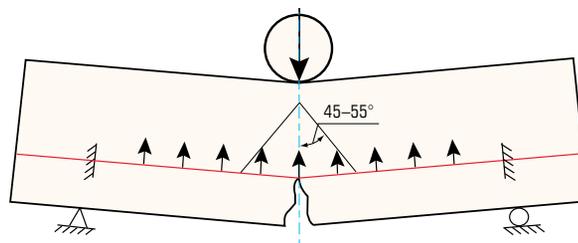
Схема работы армирующих материалов (ГМ) после разрушения нижнего слоя асфальтобетона (второй этап)
